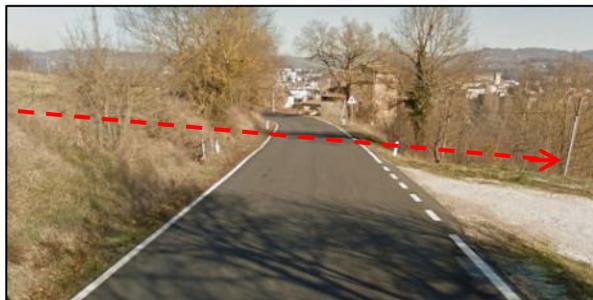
/D4 – Attraversamento trenchless S.P. n.142
